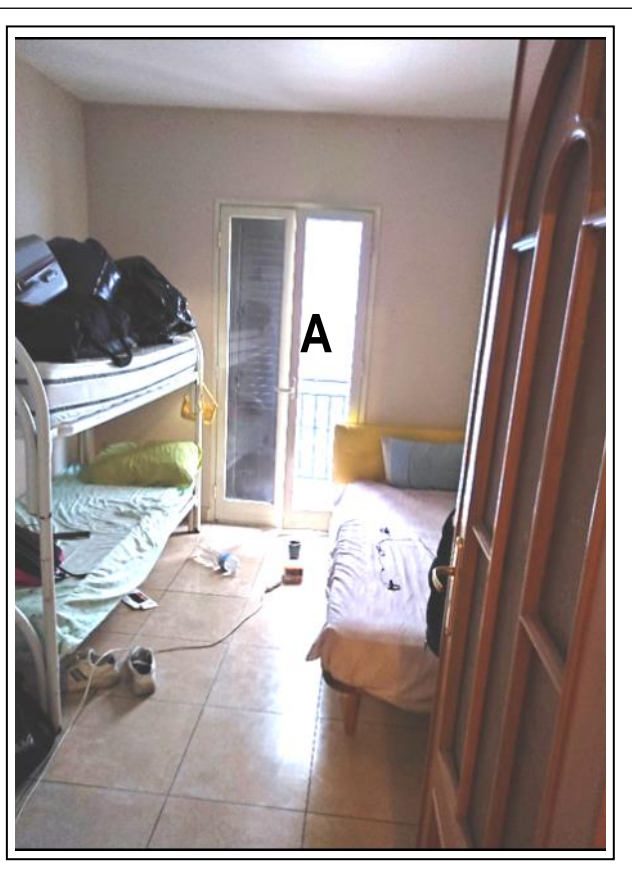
Camera da Letto 2 : (A) serramento in all.anodizzato prospiciente il balcone sulla Corte interna
